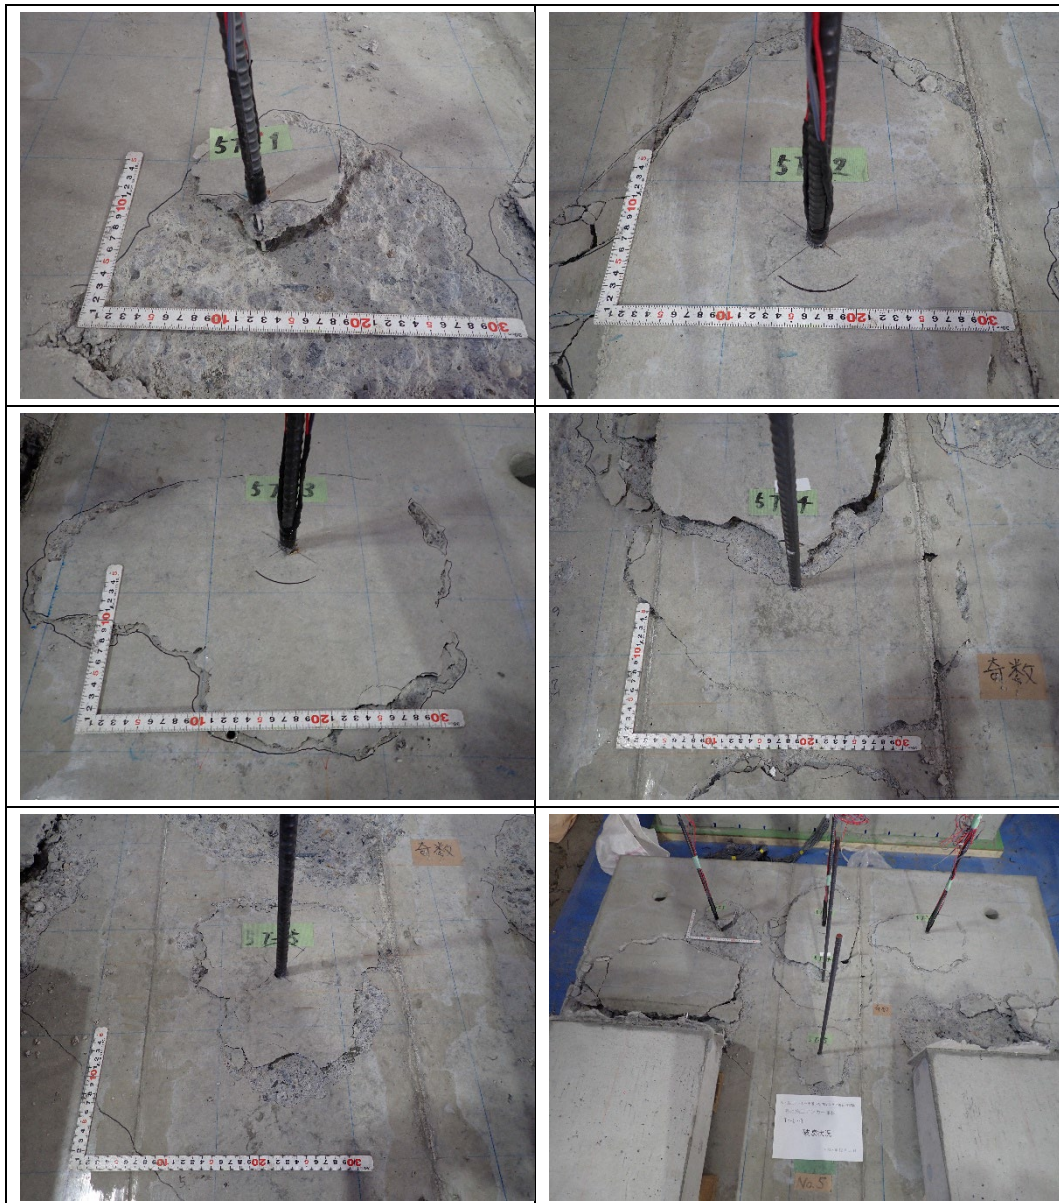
あと施工アンカー単体実験破壊状況 (5T-1～5T-5)
